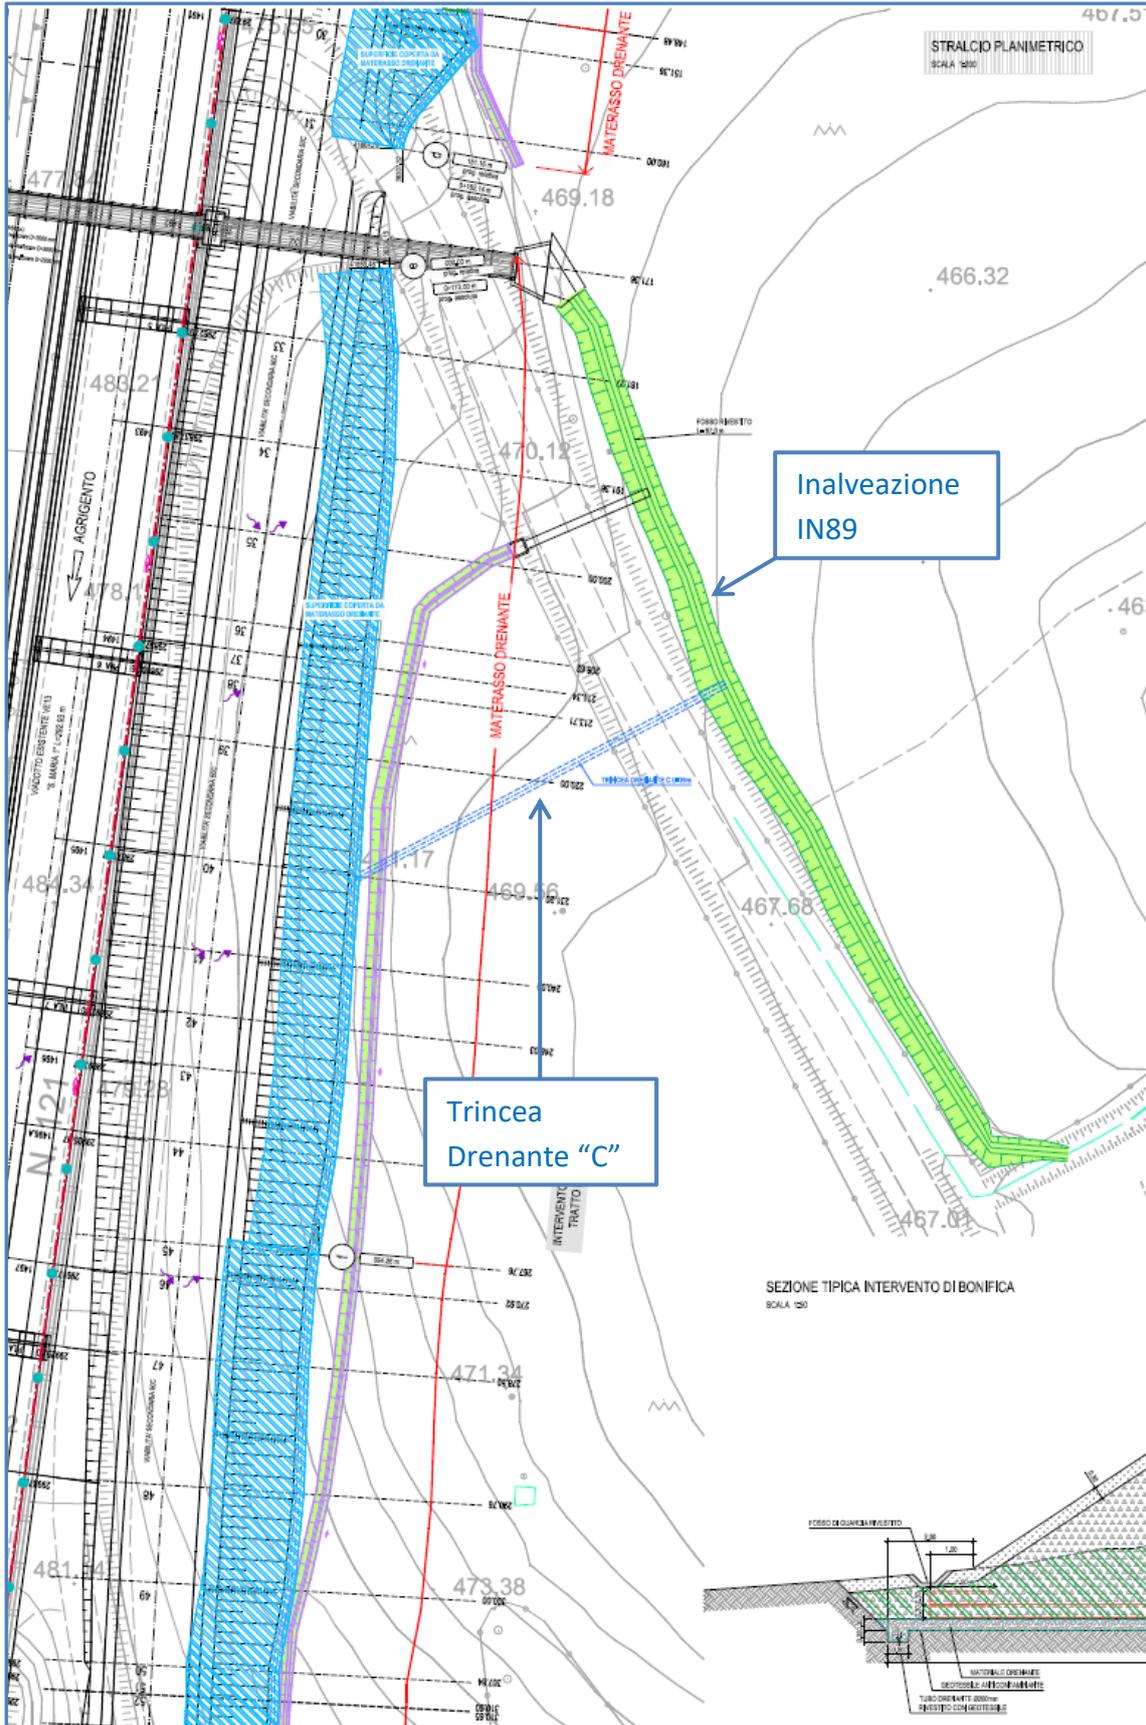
Stralcio planimetrico di progetto (Elab. Codifica PVOS117A\_N002\_51\_4137).
